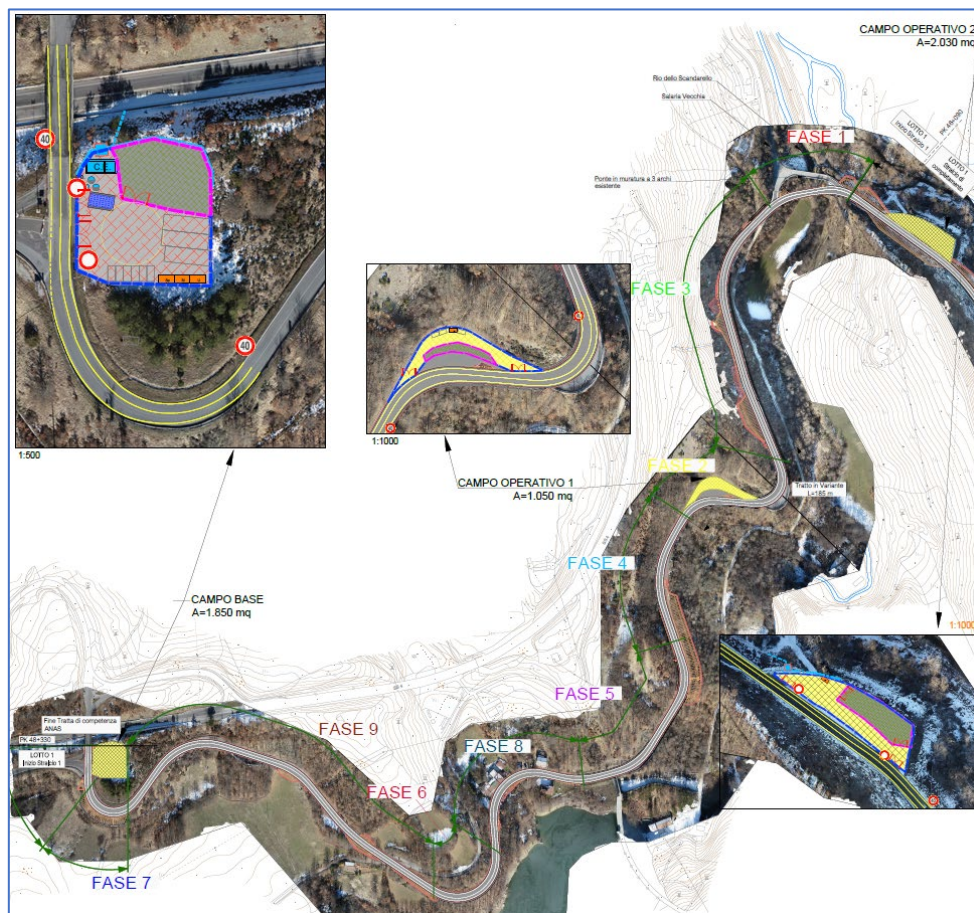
a – Stralcio 1 – Planimetria delle aree di cantiere
